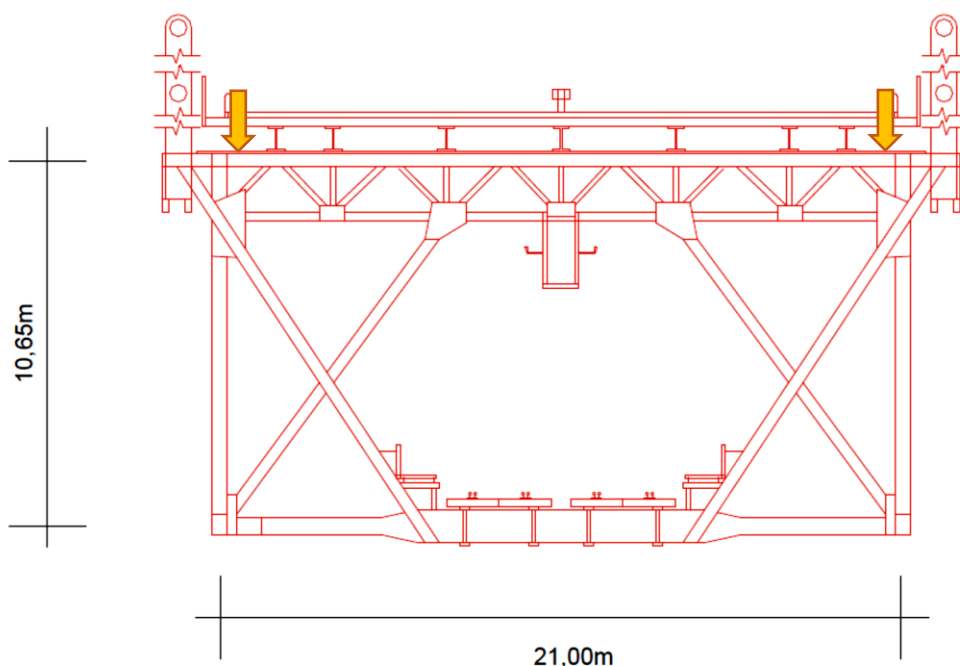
Localização das fendas nos painéis transversais da viga de rigidez
